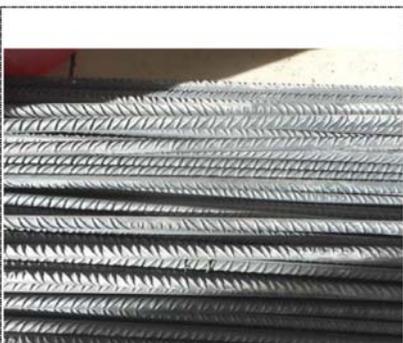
21/11/2014. Se comprueba el acero colocado. Corresponde con la especificación del proyecto.
